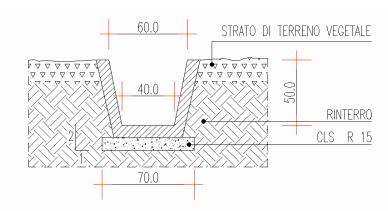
Sezione tipo delle canalette prefabbricate
